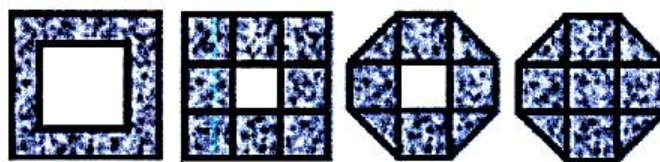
Поперечные сечения трубобетонных мостовых опор повышенной живучести [19]
